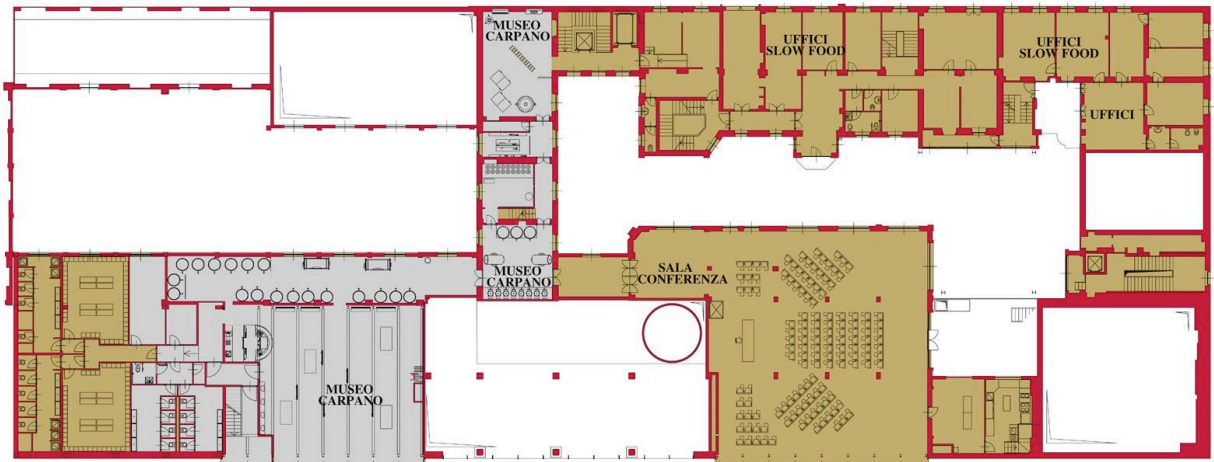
Planimetria pianta piano terra
